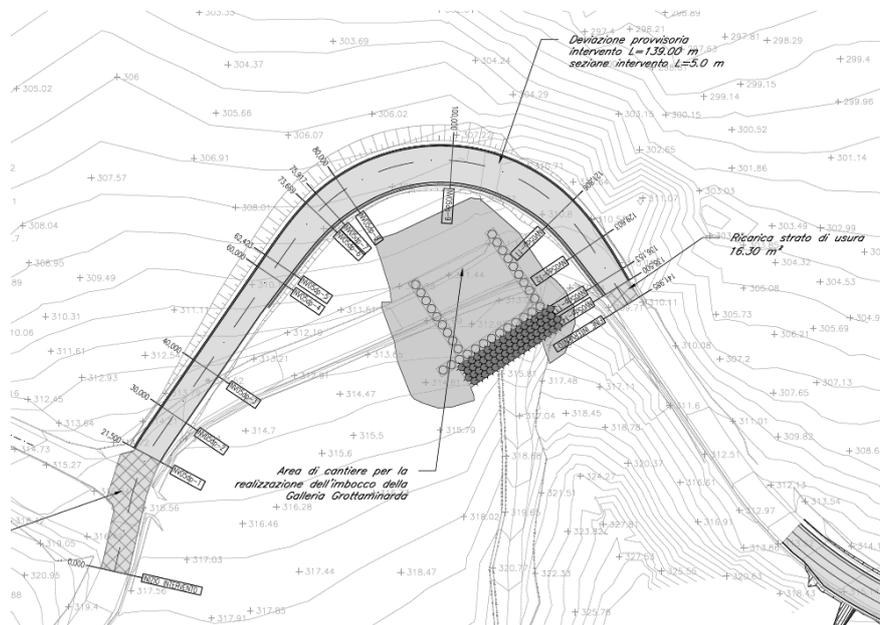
Planimetria by-pass di cui alla prescrizione in oggetto
